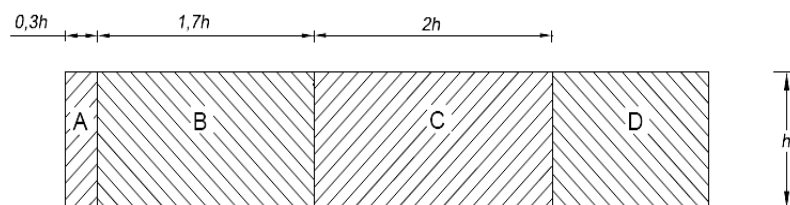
Suddivisione di muri e parapetti in aree di uguale pressione complessiva.
